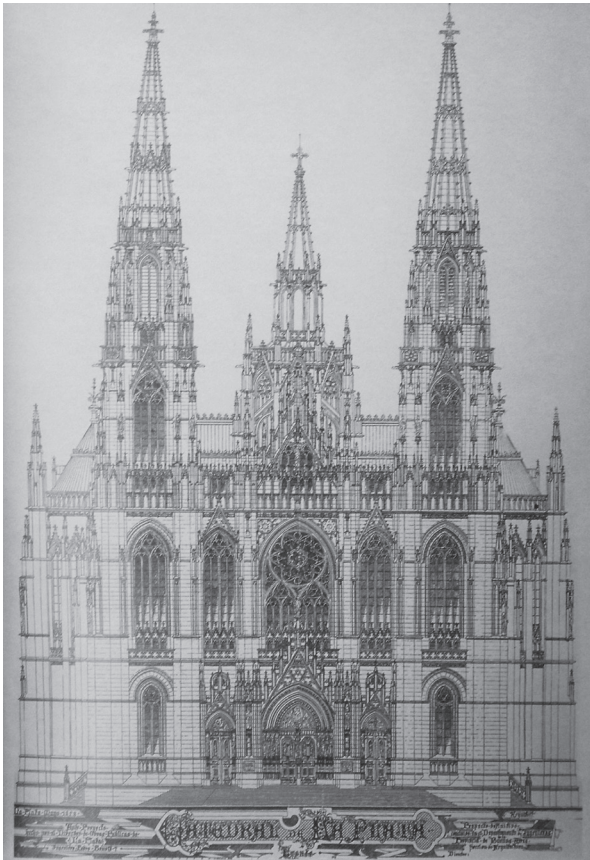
Proyecto de Benoit-Meyer para la fachada de la Catedral realizado en 1888.
